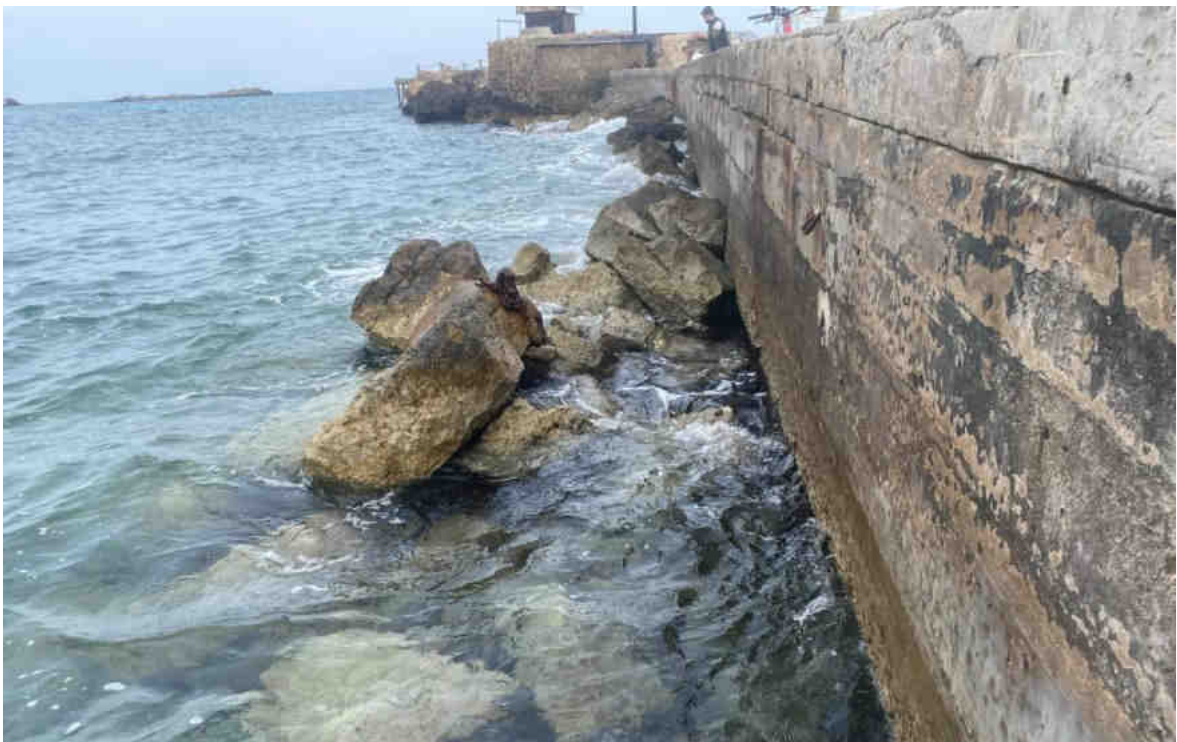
Vista del exterior del dique de abrigo y bloques de escollera de protección, en buen estado estructural.
